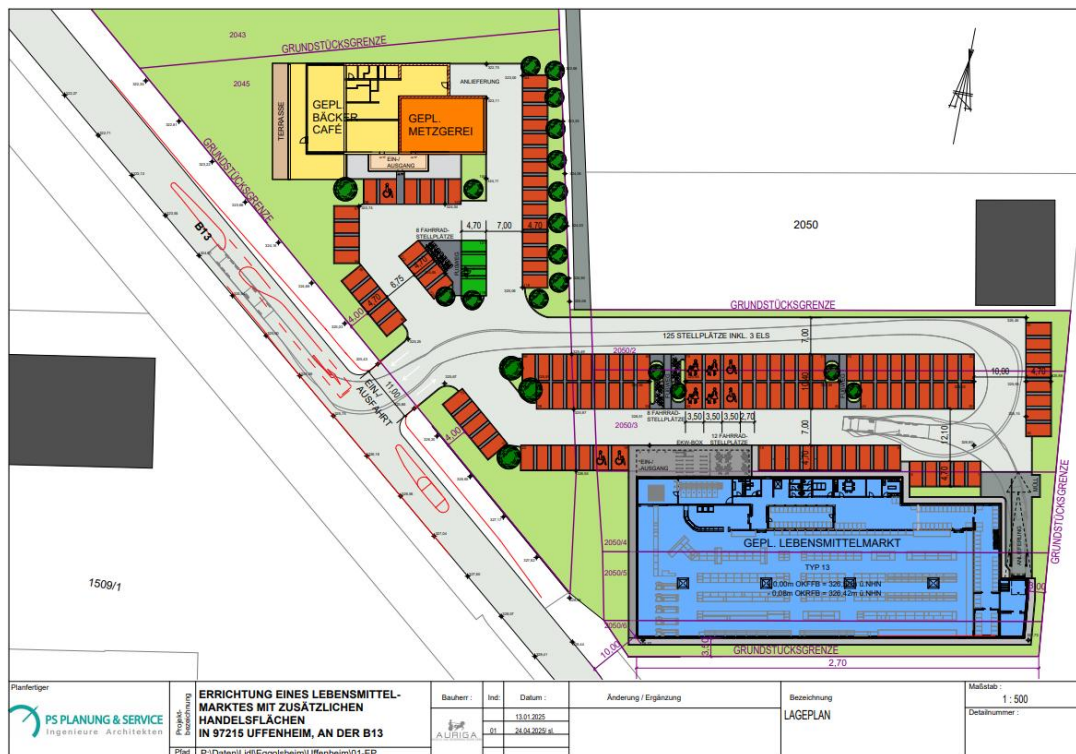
Lageplan / Grundriss (Stand 04/2025)
